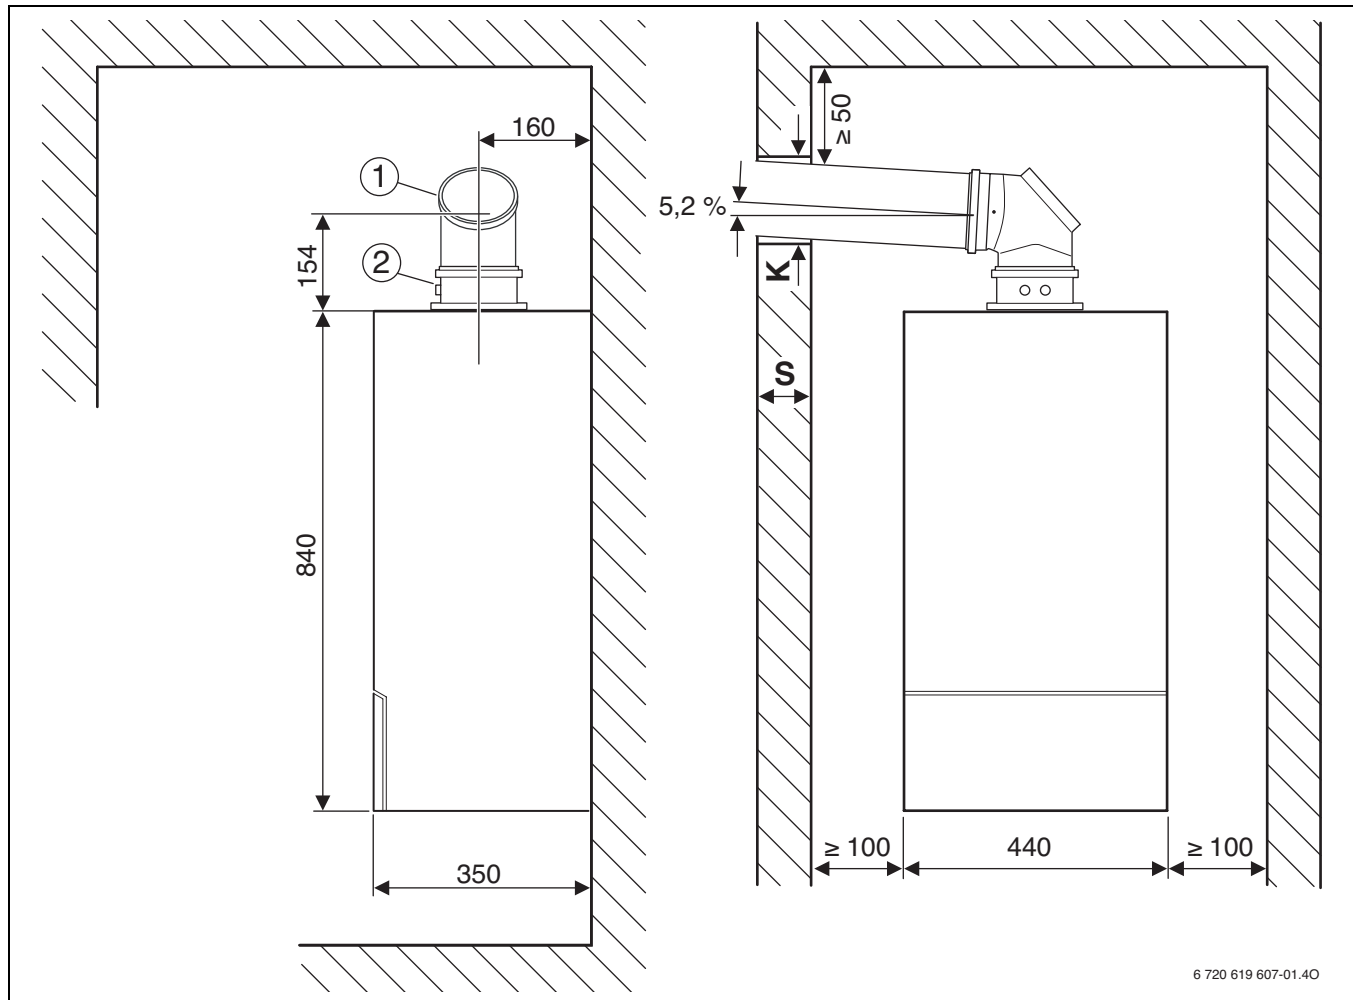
Abgasführung Ø 80/125 mm oder Ø 80 mm
